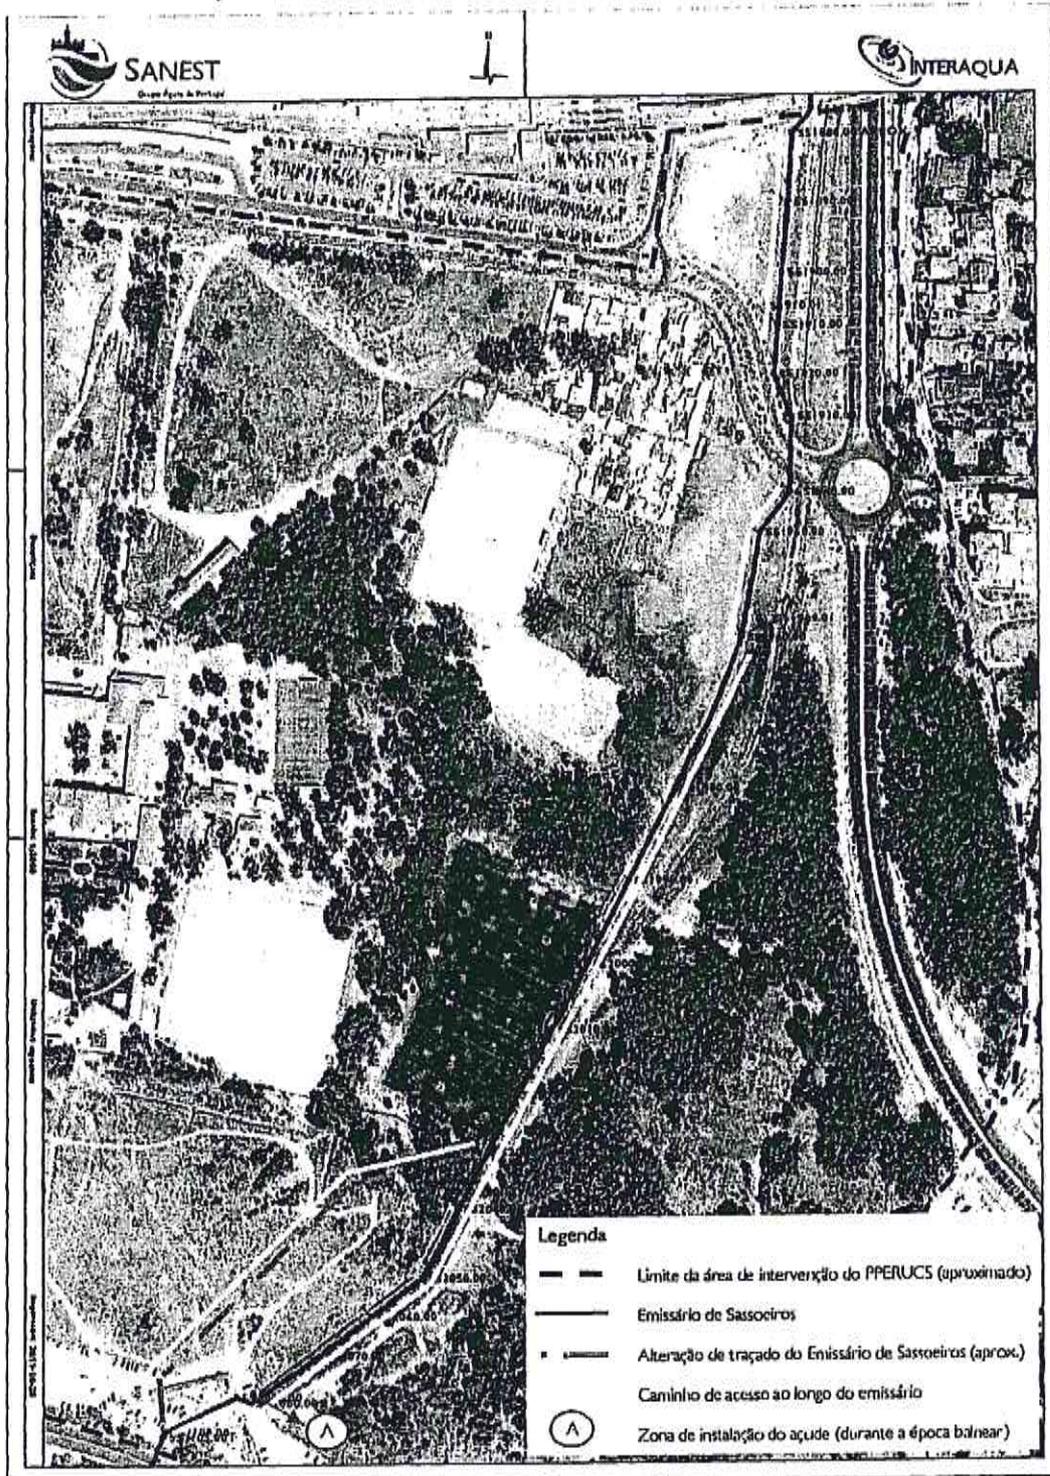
Planta de localização do Emissário de Sassoeiros na área de intervenção do PPERUCS
